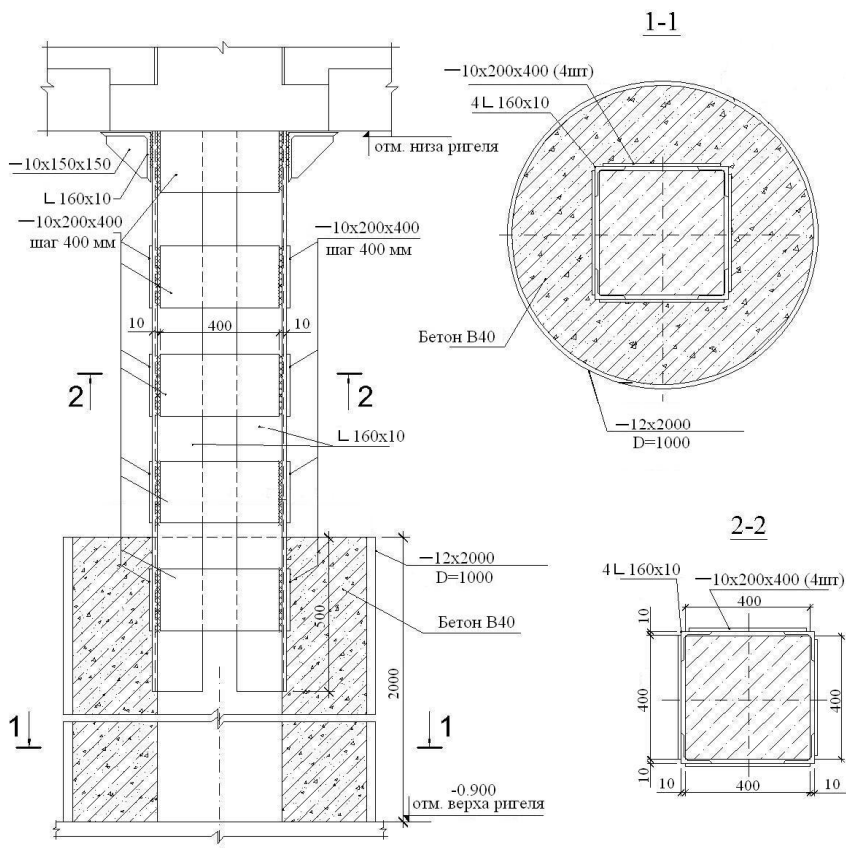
Усиление железобетонной колонны при разрушении стыка и потере устойчивости рабочей арматуры в зоне стыка
